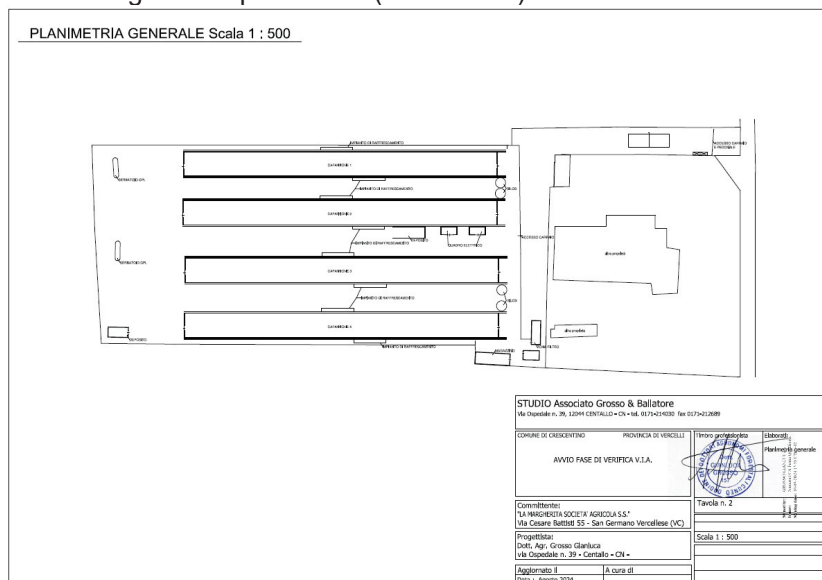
planimetria generale dello stabilimento (estratto elaborato 2 presentato)
